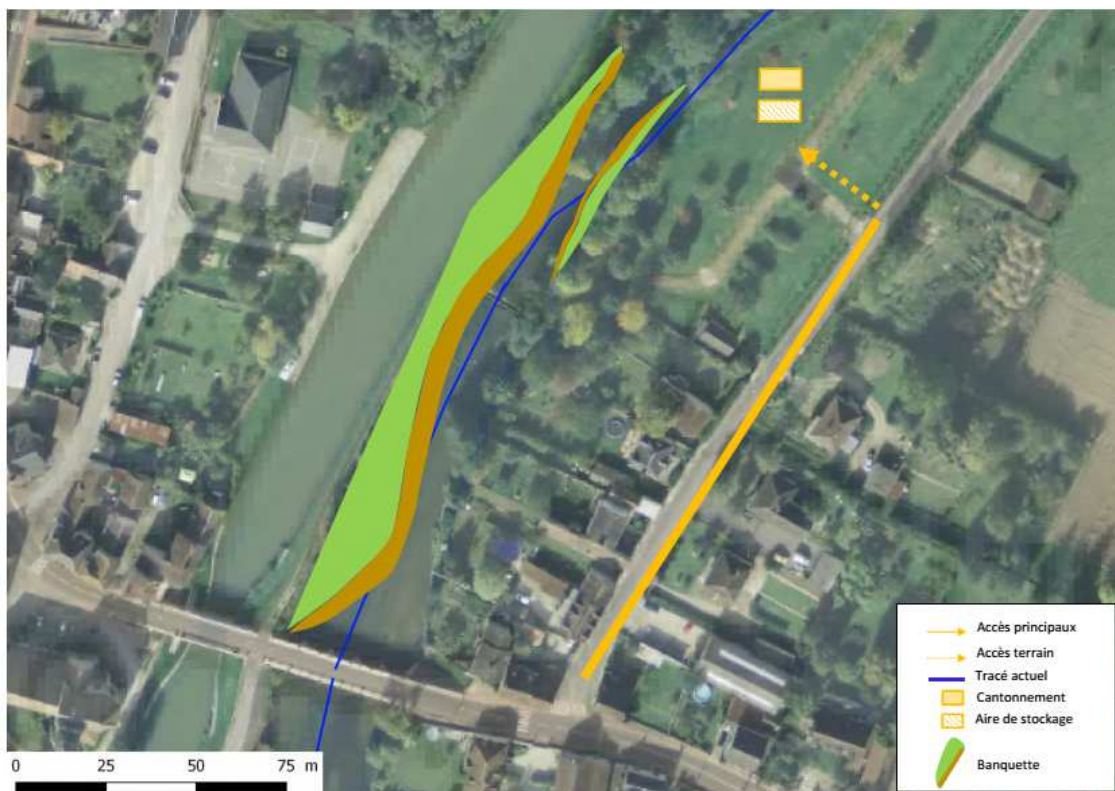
Accès et installations de chantier sur le site de Montbouy
